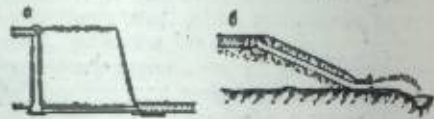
Напорные перепад: а — шатный; б — трубчатый.
